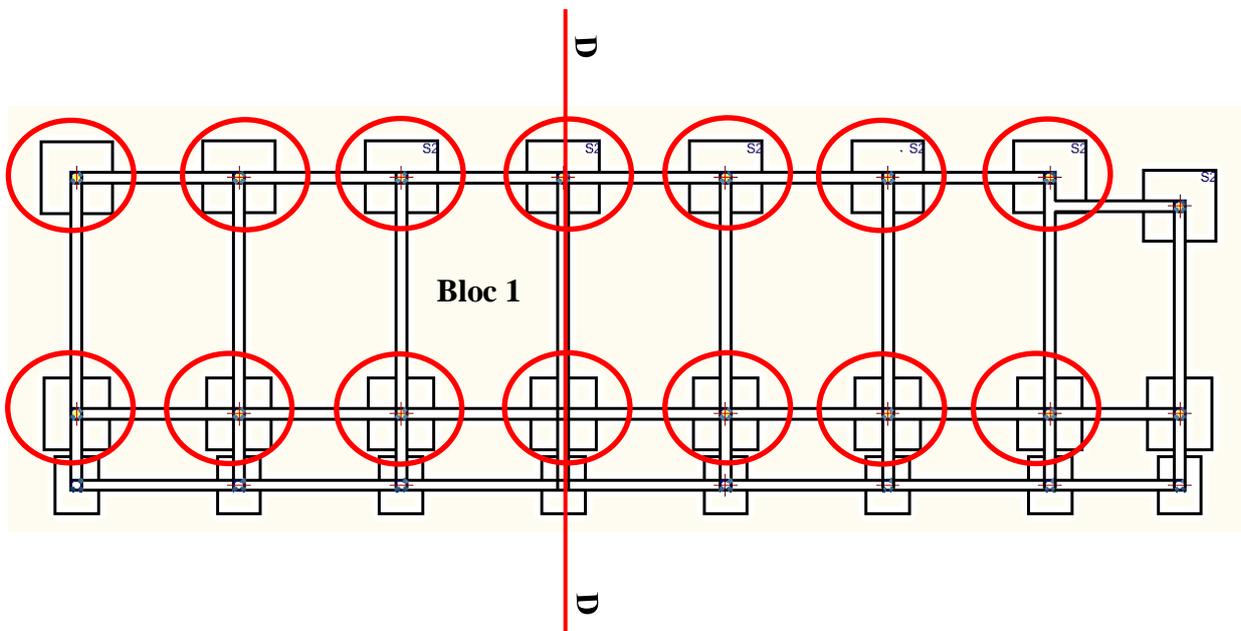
Augmentation de dimensionnement des semelles (plan de fondation)
